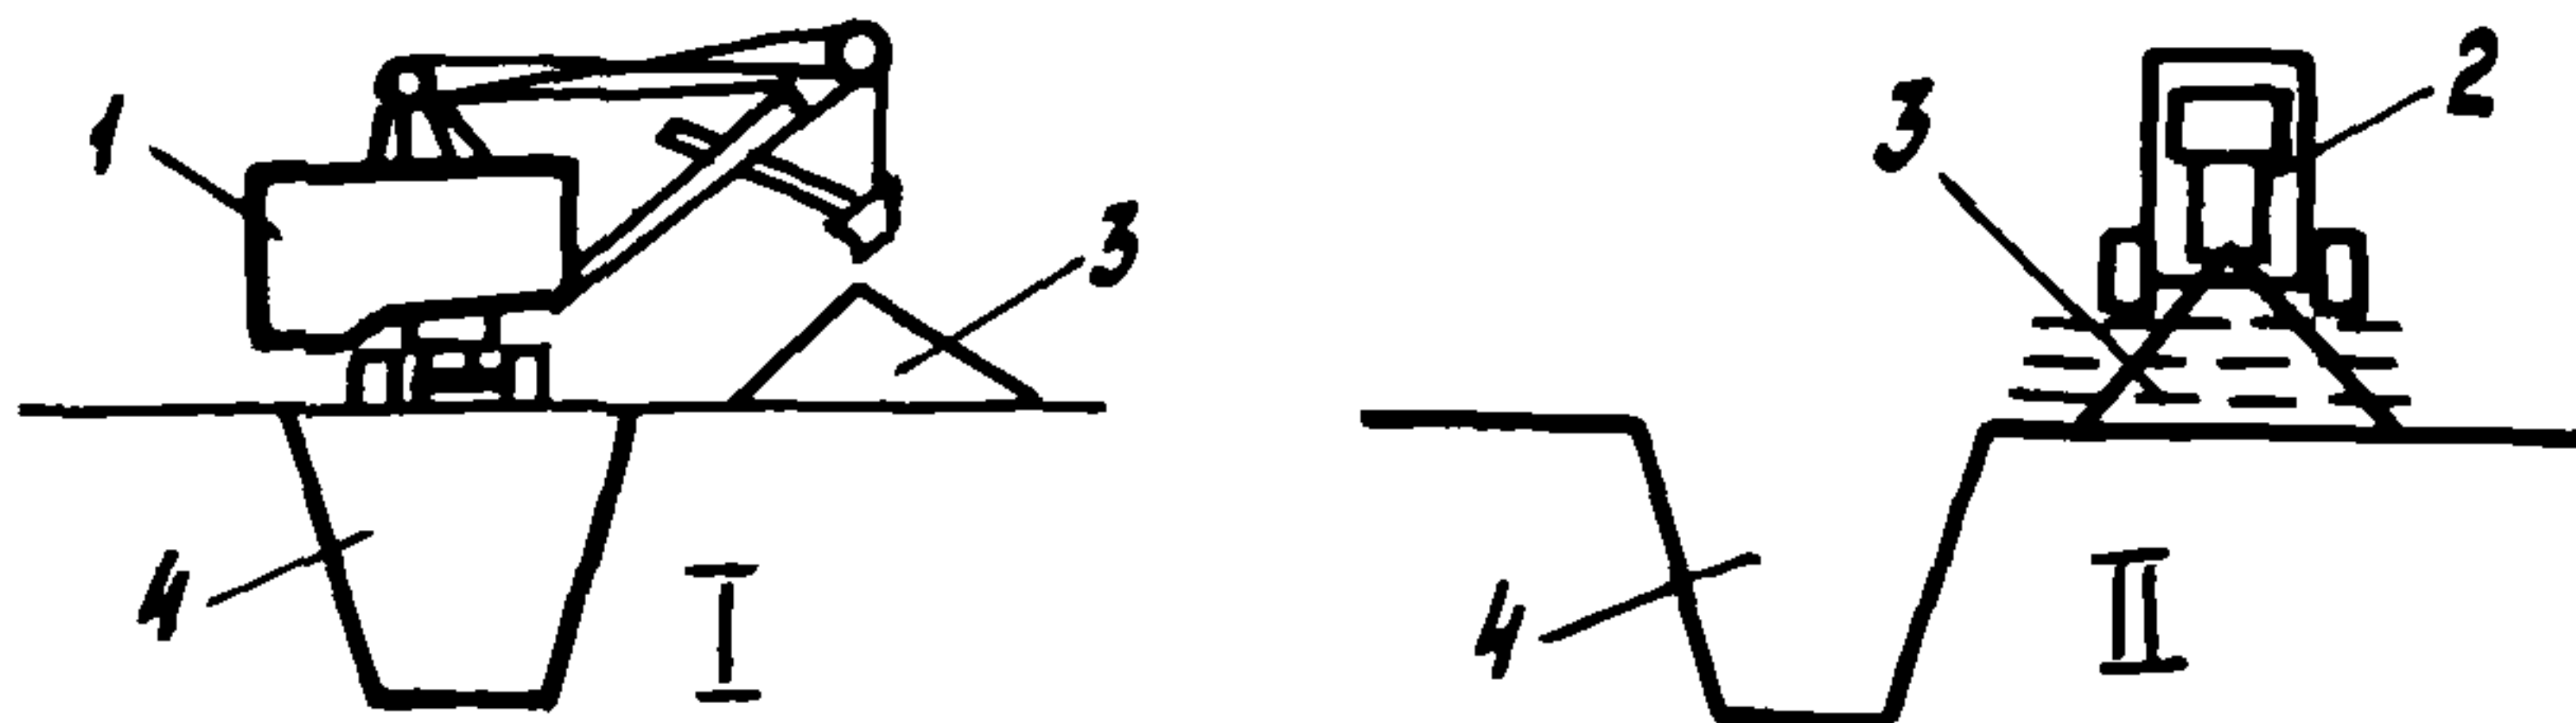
Разработка траншей в стесненных условиях с использованием одноковшового экскаватора, с укладкой отвала грунта на рабочую полосу с последующей его планировкой бульдозером:
